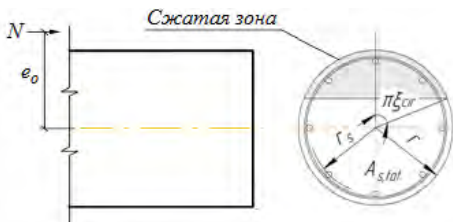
Схема к расчету внецентренно сжатой колонны круглого сечения
